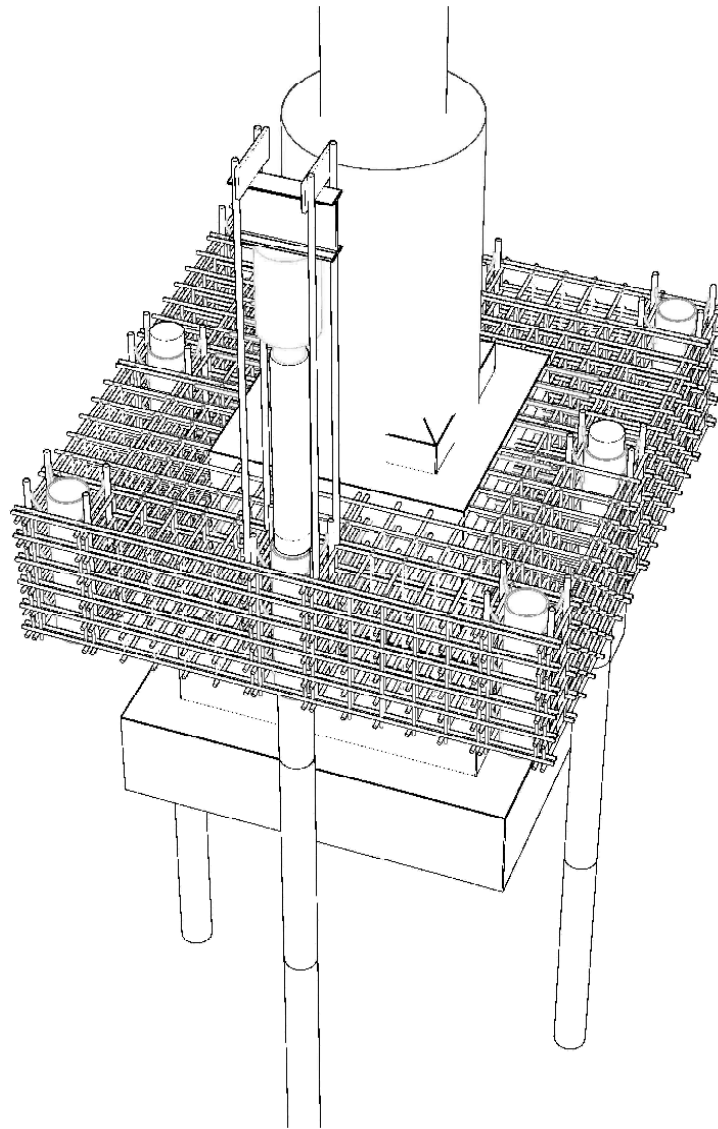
Принципиальная схема армирования ростверка с установкой основных и дополнительных гильз и упорной конструкции для погружения свай
